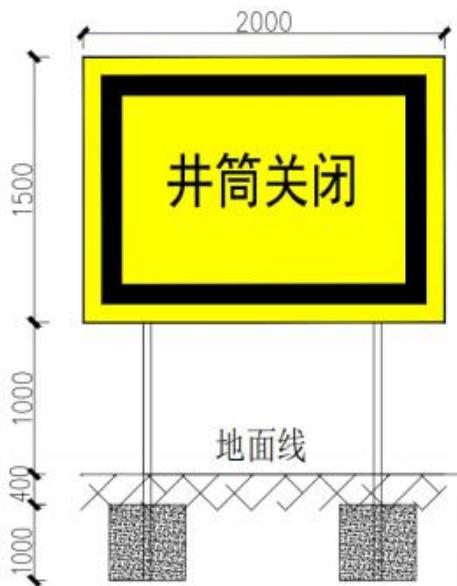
警示牌示意图（图中尺寸单位为 mm）
